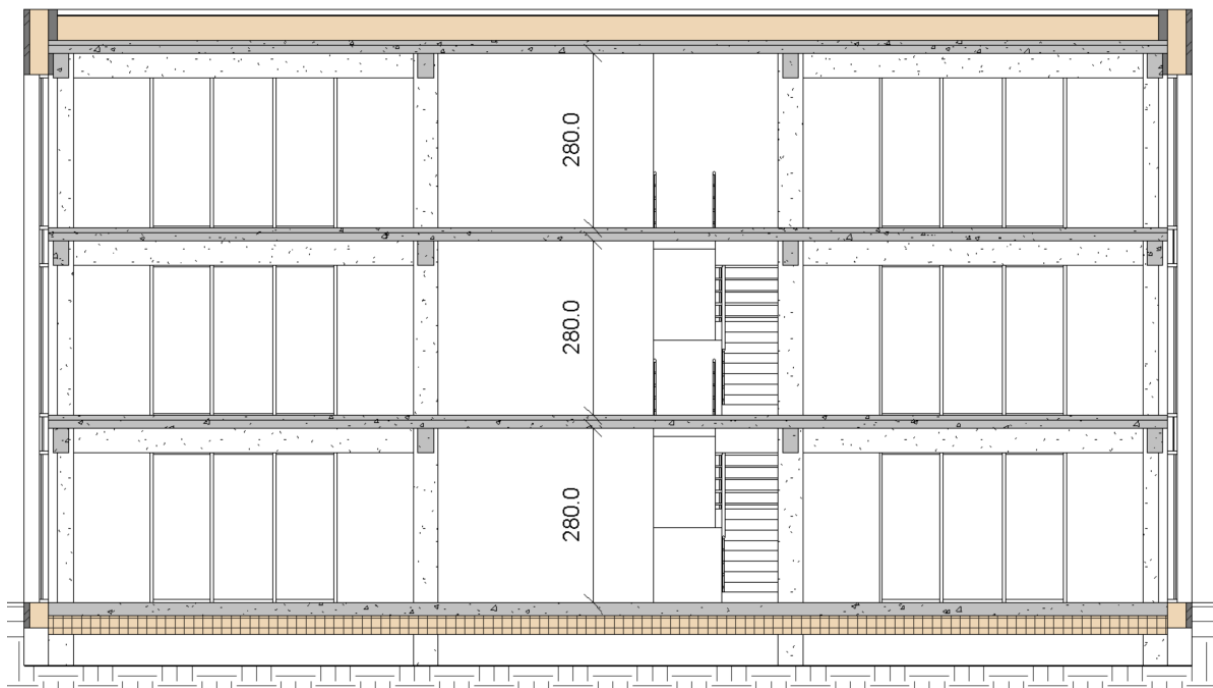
Coupe NC1 – Reconstruction traditionnelle passive +
